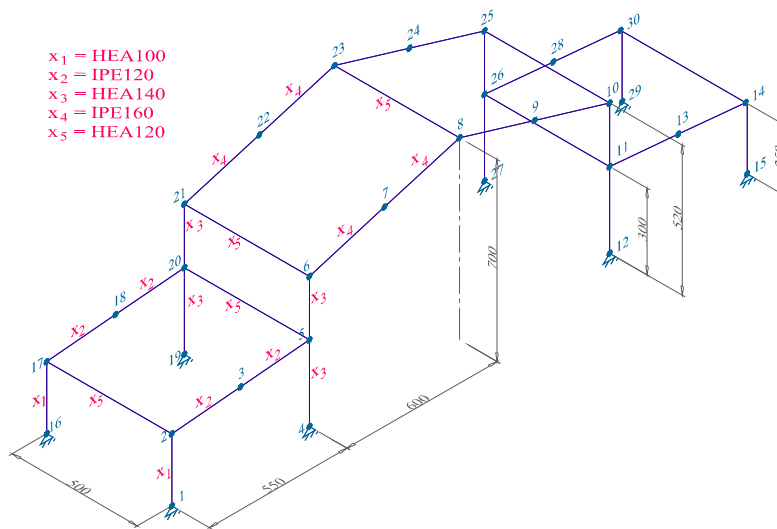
Agrupación de barras en la estructura de pórticos (cotas en cm).
